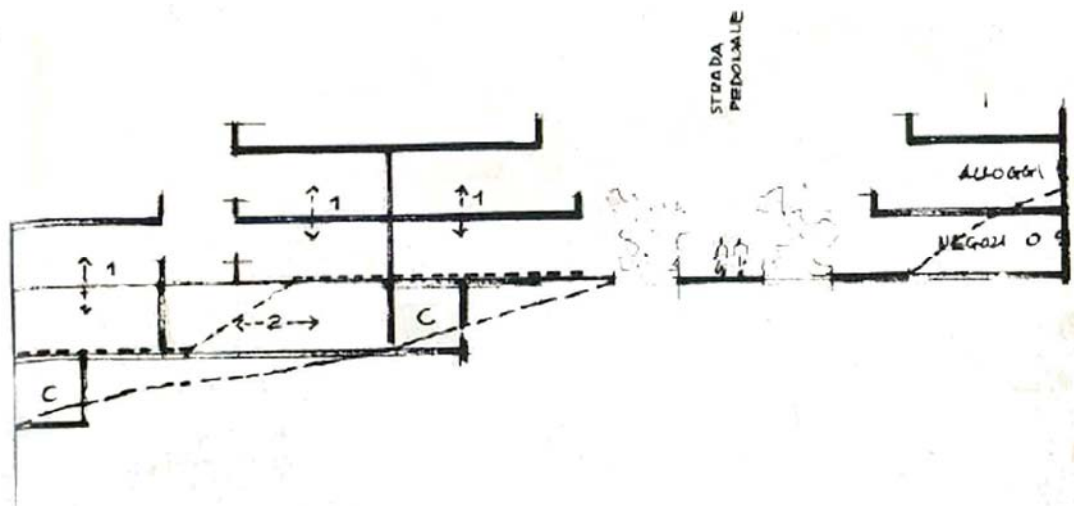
Schizzi di studio in sezione per la sistemazione degli edifici sui terrazzamenti del terreno
